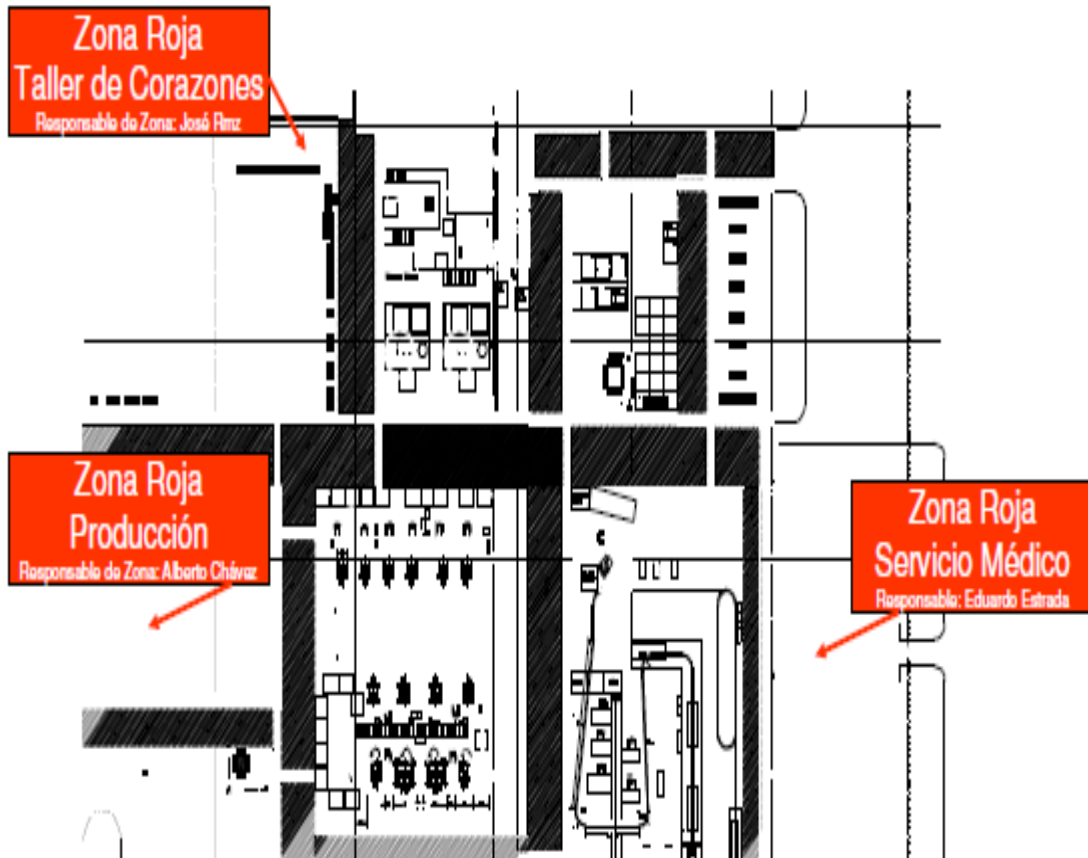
Ubicación de Zona Rojas en la planta de Autometales
